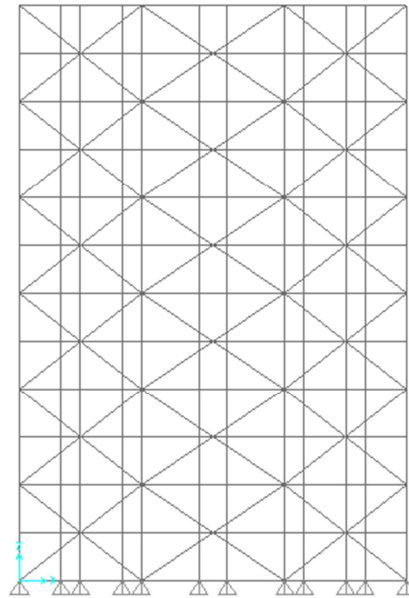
Configuração dos Planos de Contraventamento Vertical Com Elementos de Contraventamento Grandes
